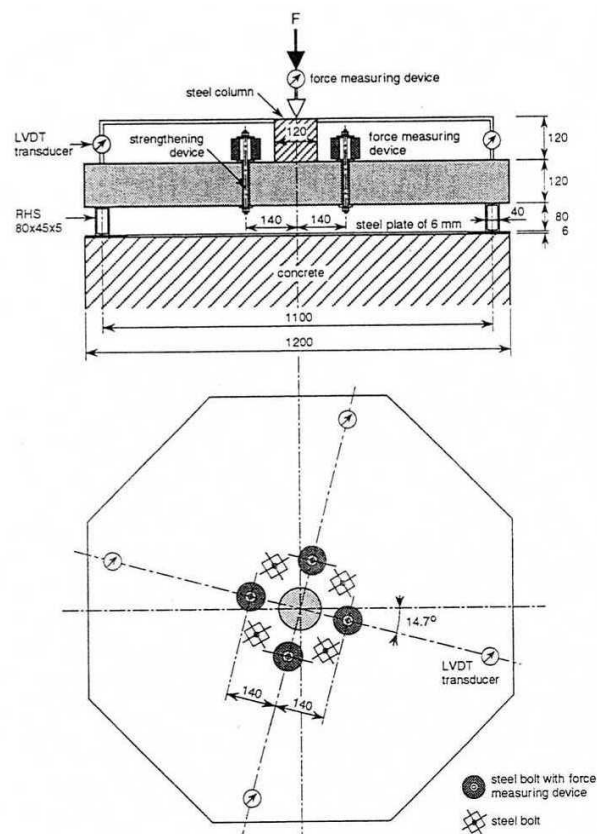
Geometria e condições de fronteira das lajes octogonais de Menétrey e Brühwiler
